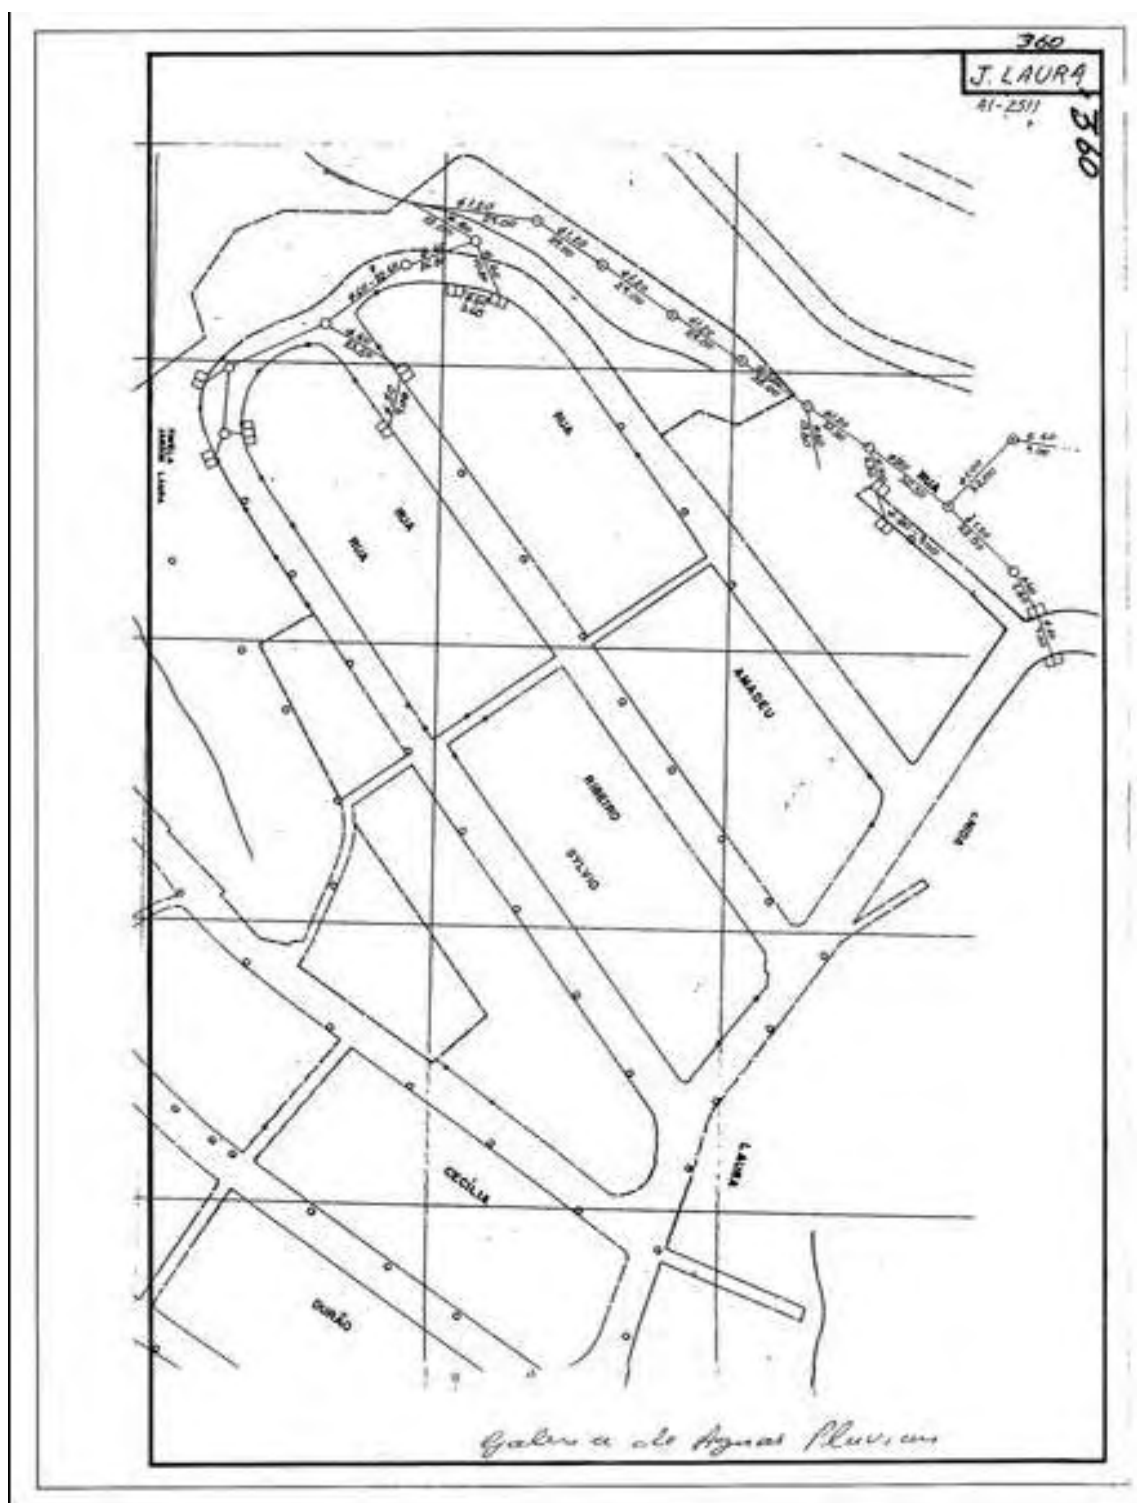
Planta de galerias de águas pluviais no Jardim Laura (Bacia do Alvarenga)
